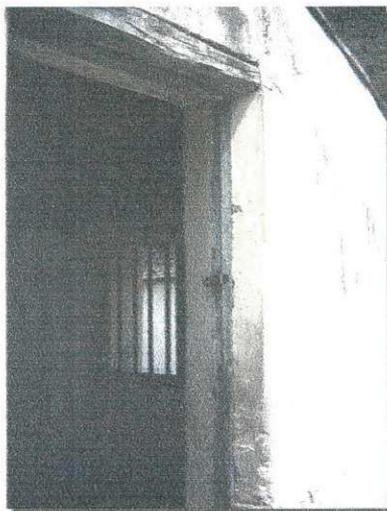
Alvenaria com 60cm de espessura, em tijolos de adobe
